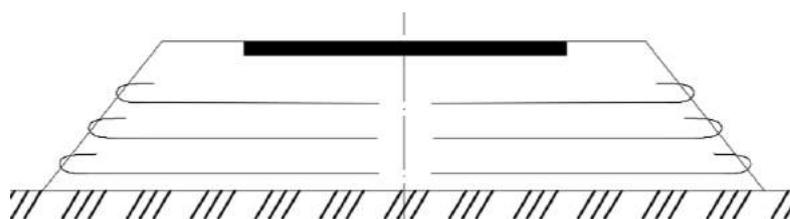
Армирование насыпи большими шагами и горизонтальными слоями
